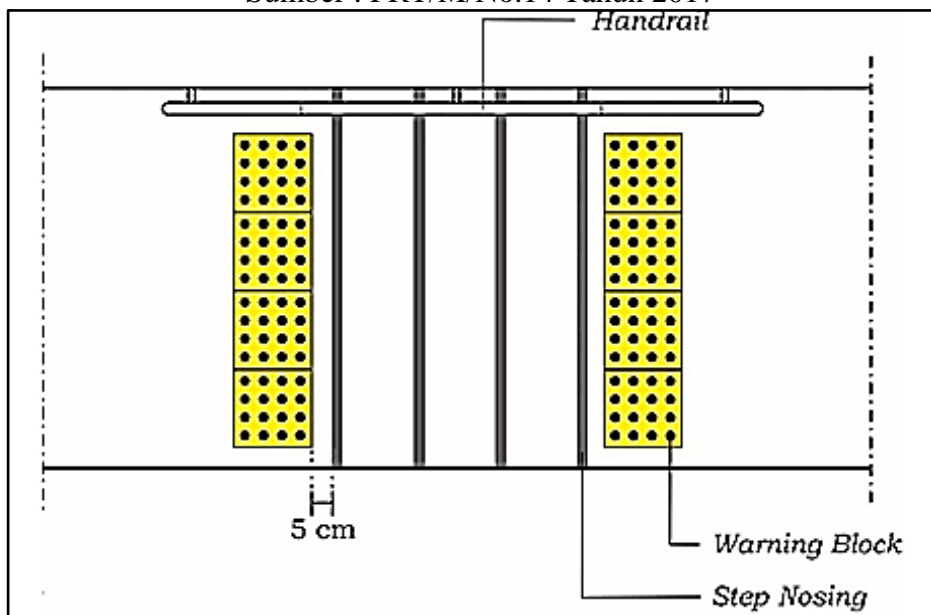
Pegangan rambat handrail yang direkomendasikan
